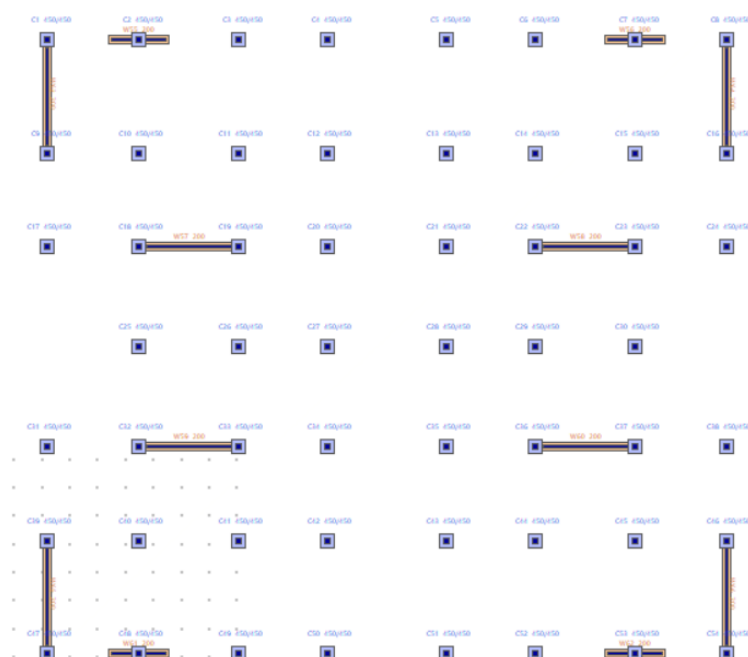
Plan en vue en dessous du niveau 1 de la structure à appuis isolé
